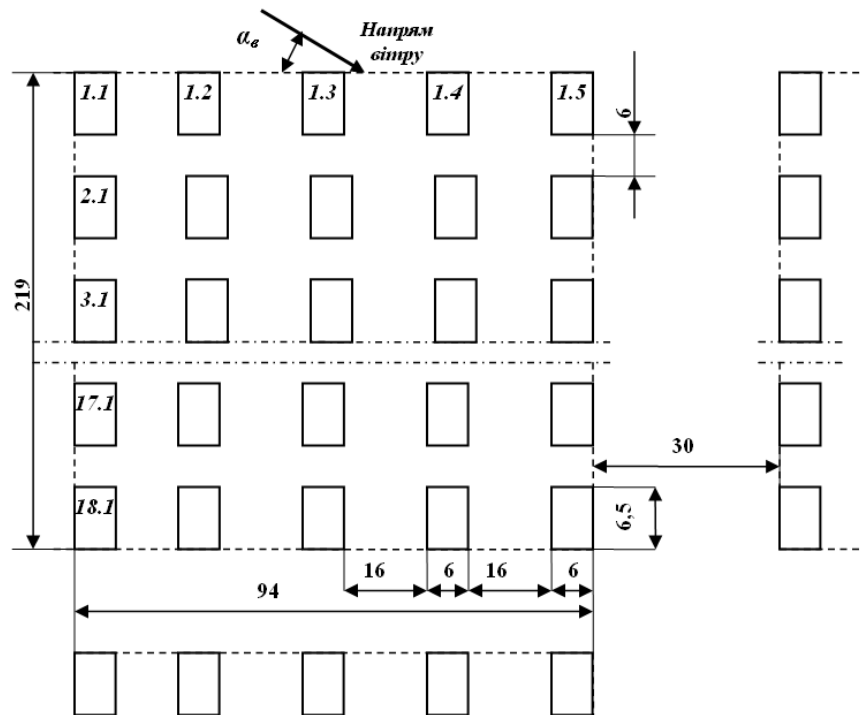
План кварталу складу круглих лісоматеріалів штабельного зберігання
